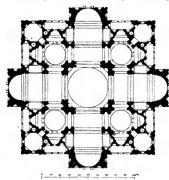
St. Peter. Bramante's erster Grundriss.
